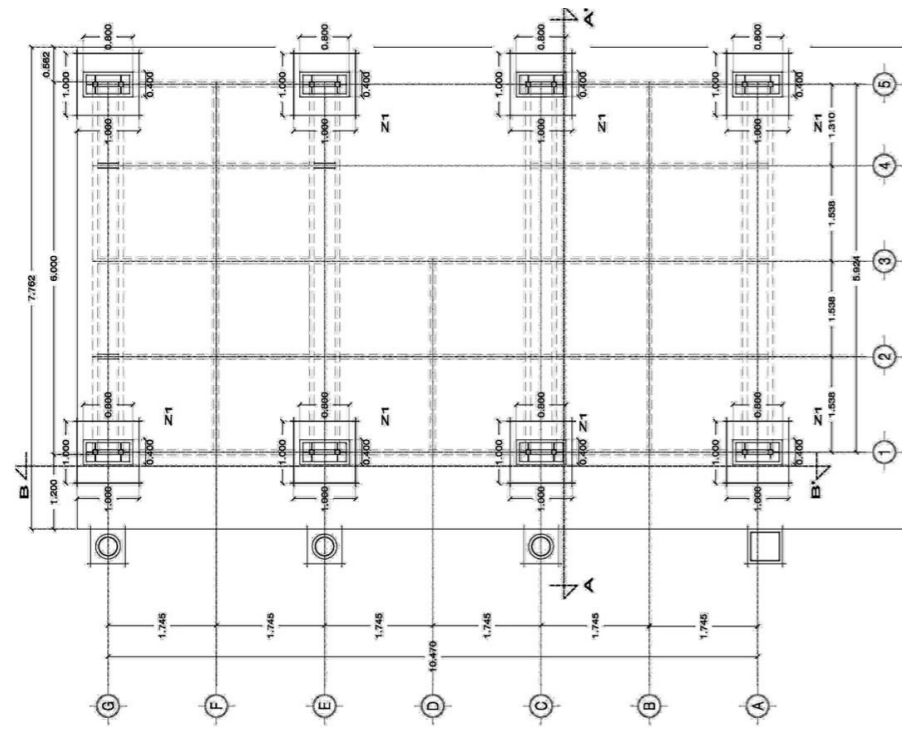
Modulación de espacios con estructuras ligeras, fuente: Archdaily.mx
